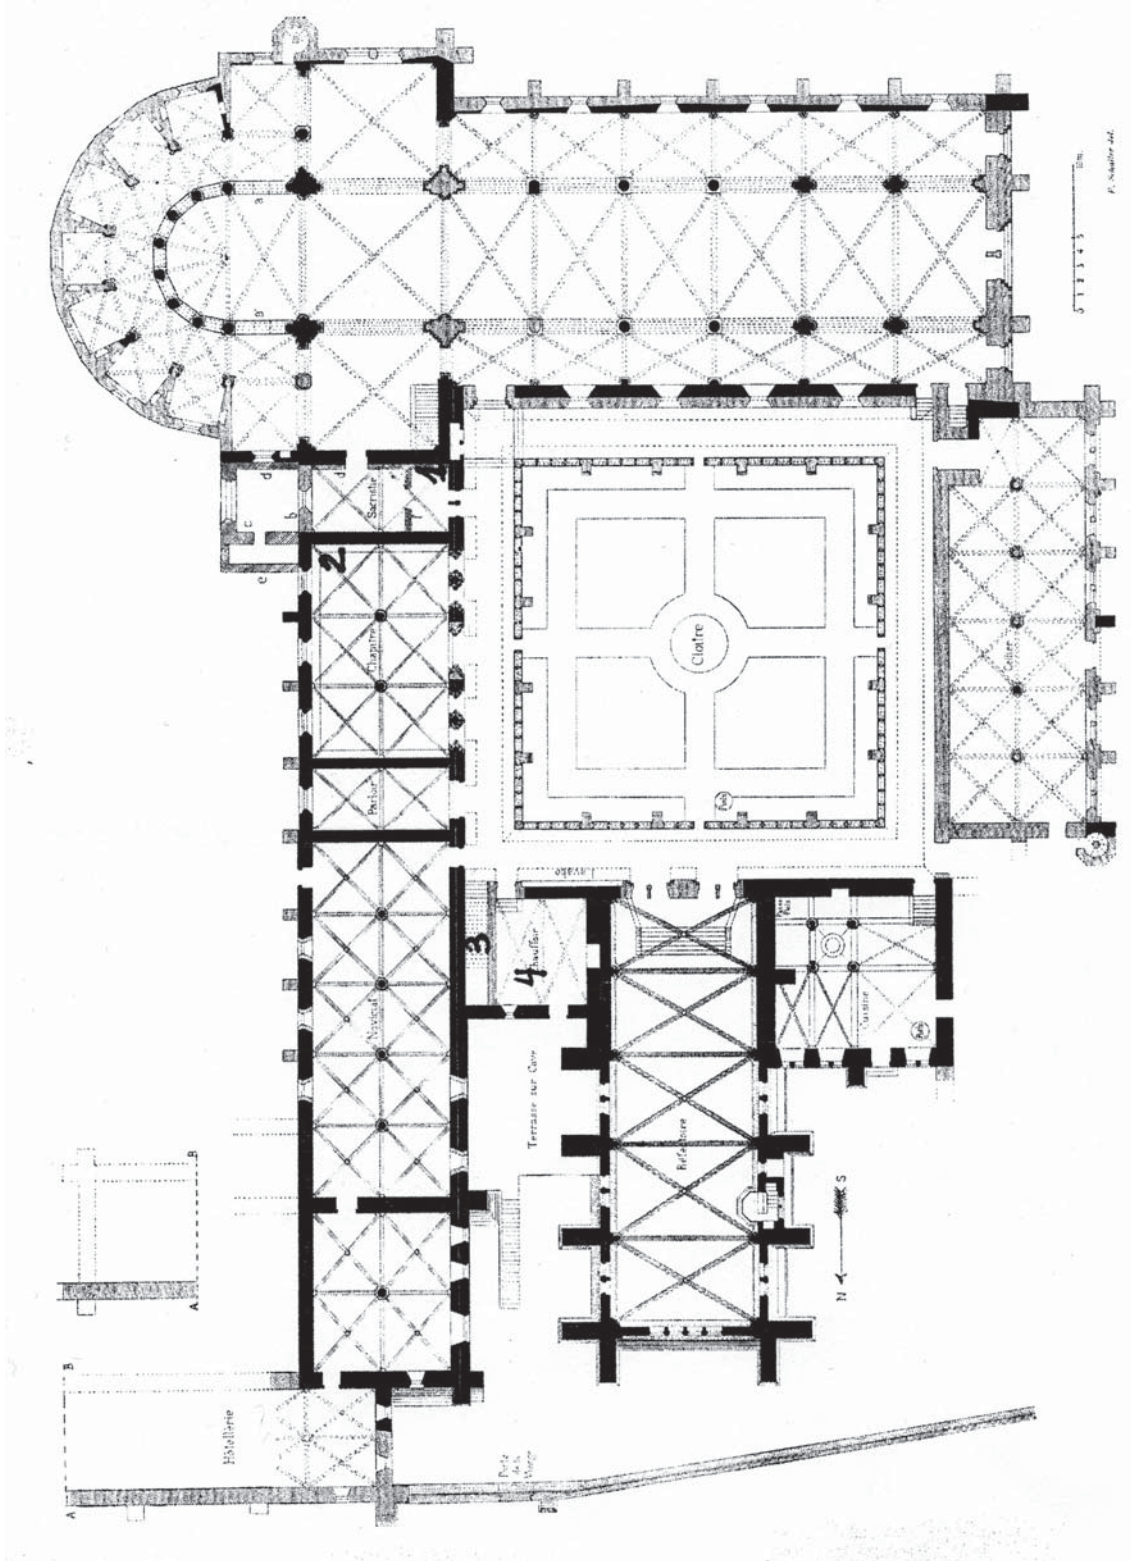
Plan de l'abbaye de Bonport par F. Schaller. Escaliers en n° 1-4
